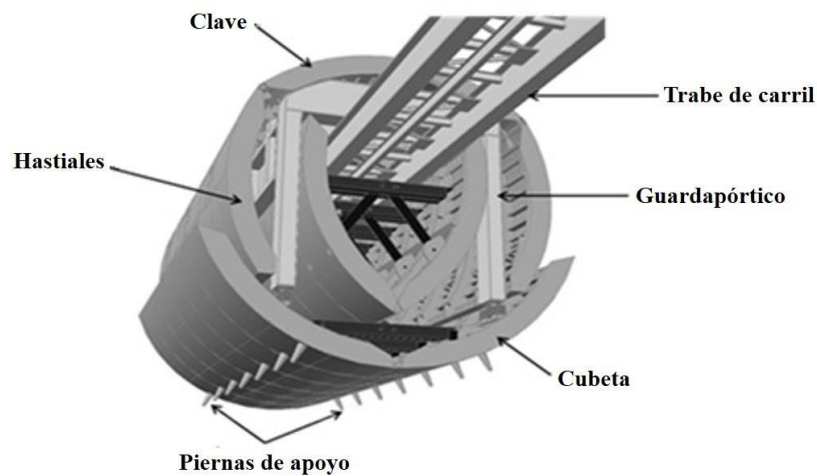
Cimbra metálica telescópica. Tomada de Villanueva (2013).
